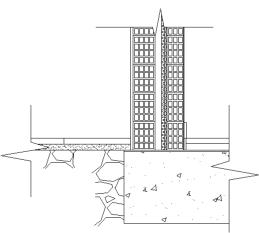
Arranque de fachada de doble hoja, enfoscado. Fuente: Edición propia
